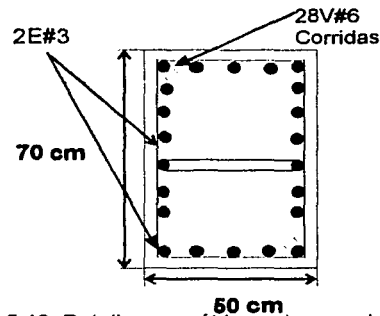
Detalle geométrico y de armado de la columna C1E
